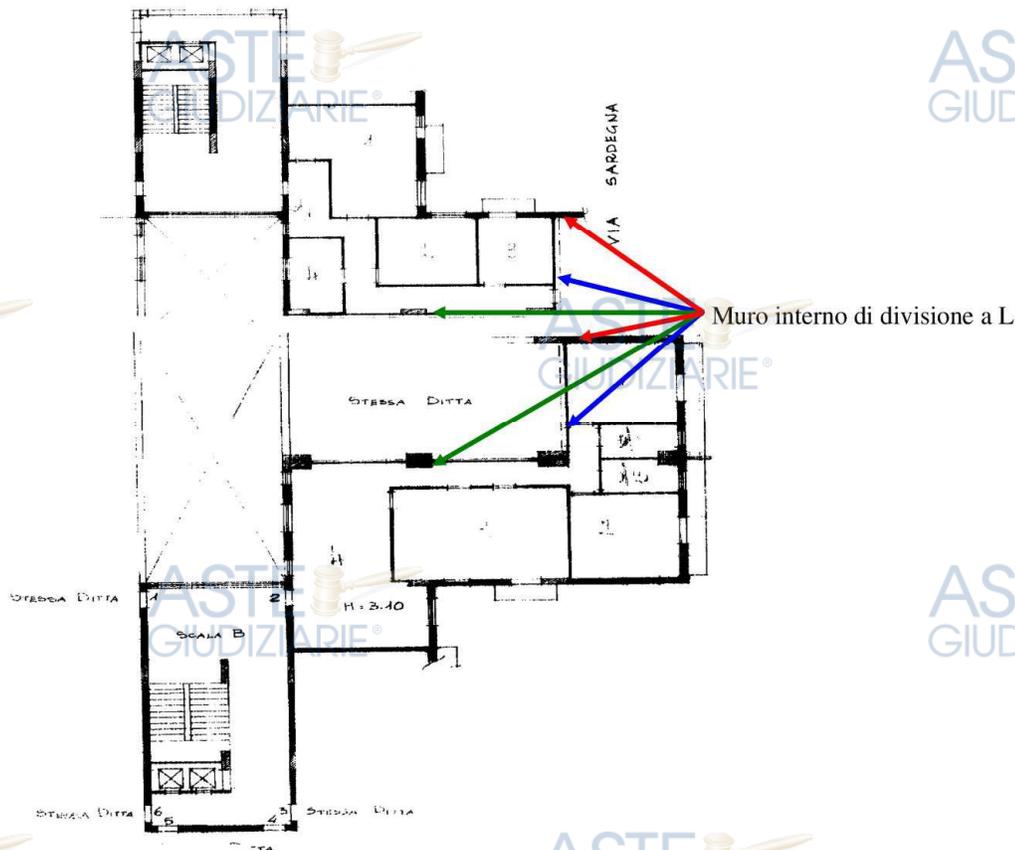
Planimetria Foglio 119 particella 133 sub 135 (immobile pignorato)
